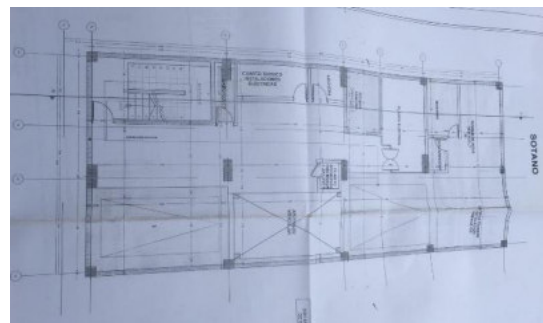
Fotografía tomada al plano suministrado por la arquitecta responsable de la obra.
